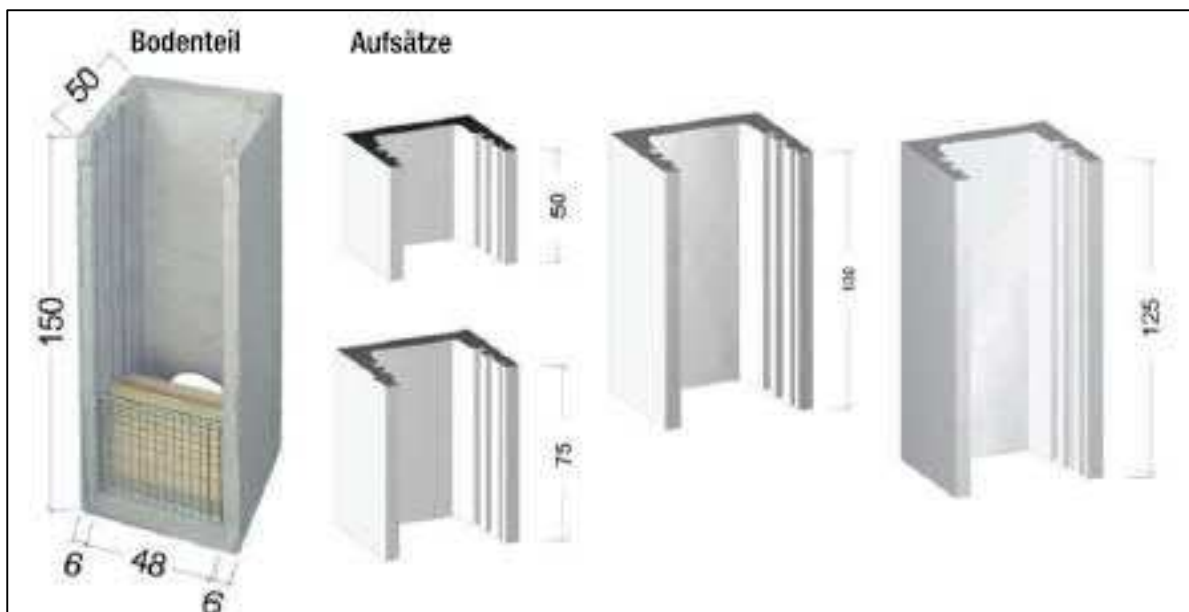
Aufbau eines Mönchbauwerks (© Beton Bernrieder, 2024)
